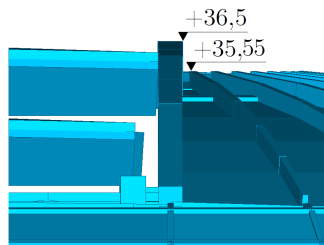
Coupe au niveau de la méga-poutre.
